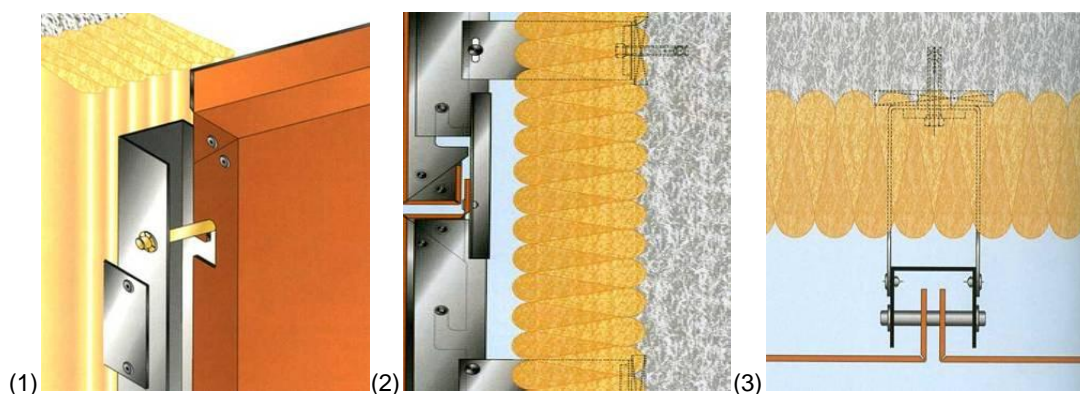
Detalhe da fachada ventilada com alumínio tracamada(1), corte vertical(2) e corte horizontal(3)
